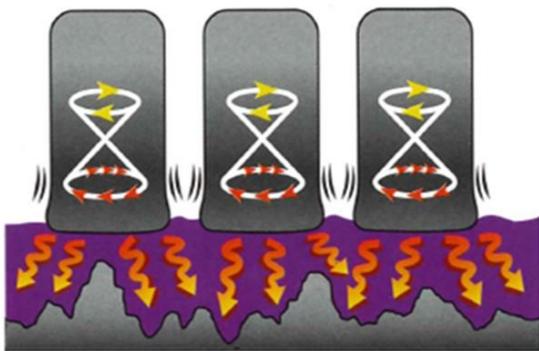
Esquema demuestra el efecto de unión entre el nuevo pavimento y el superficie del pavimento viejo fresado
